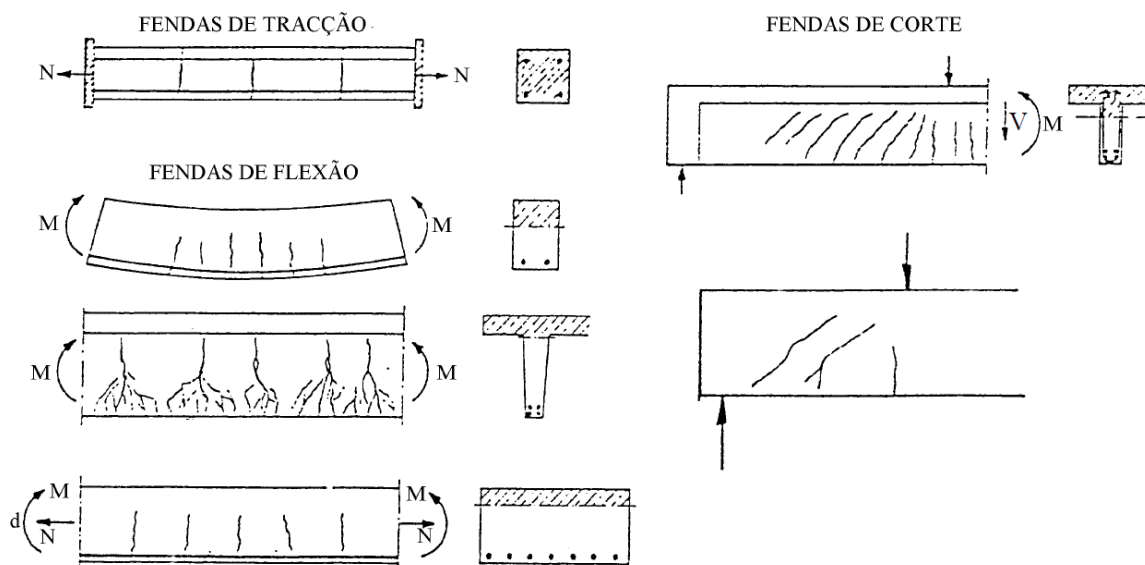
Fissuração originado por cargas aplicadas. Adaptado de Figueiras (1997)
